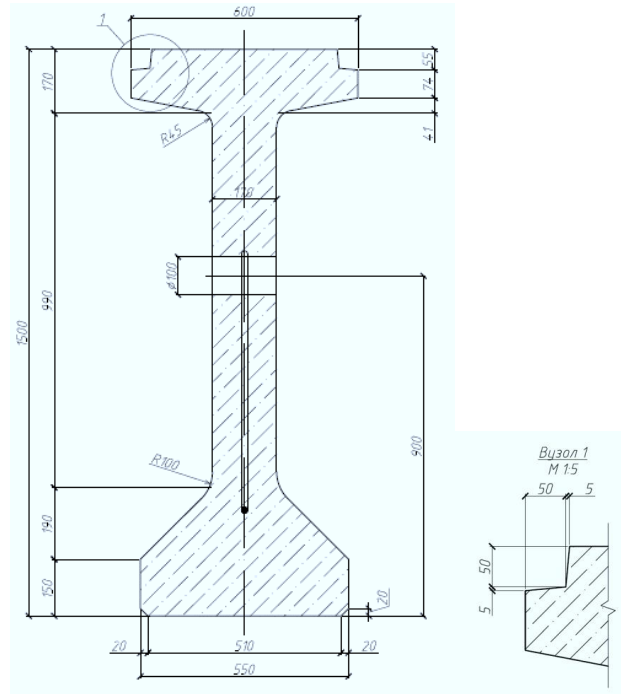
Переріз балки 33 м згідно робочого креслення 124/20-КЗ.В-03
